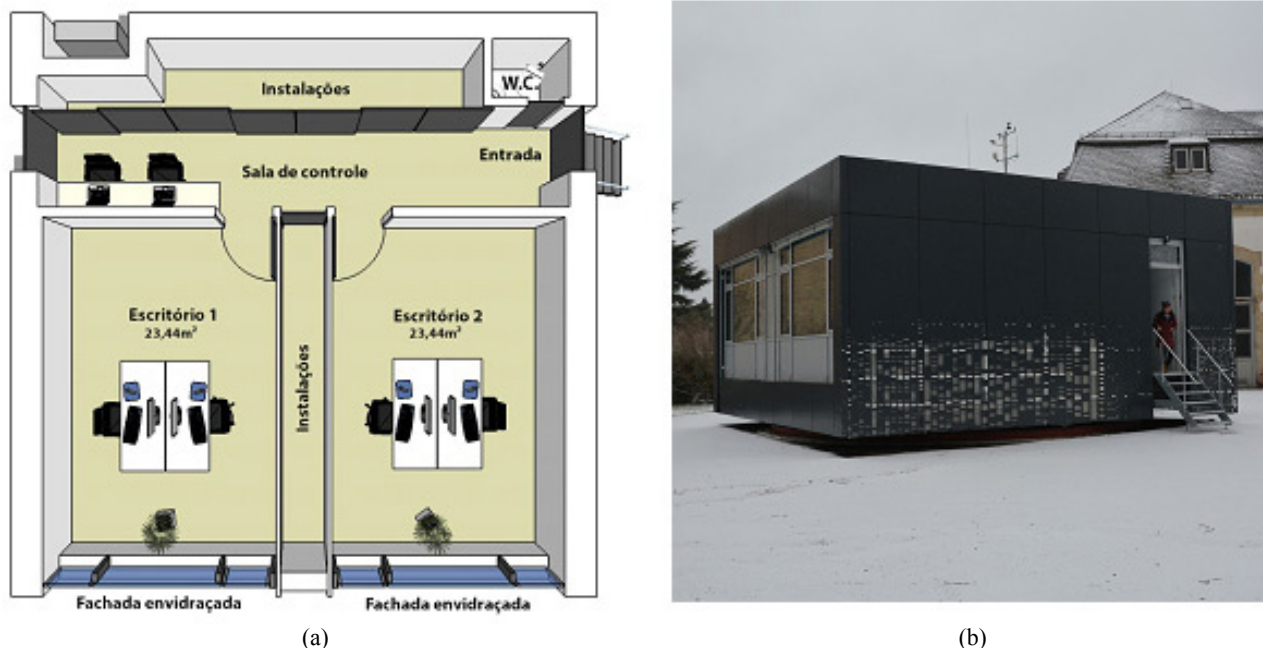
(a) Planta do LOBSTER; (b) vista externa geral da câmara climática e das aberturas envidraçadas.
